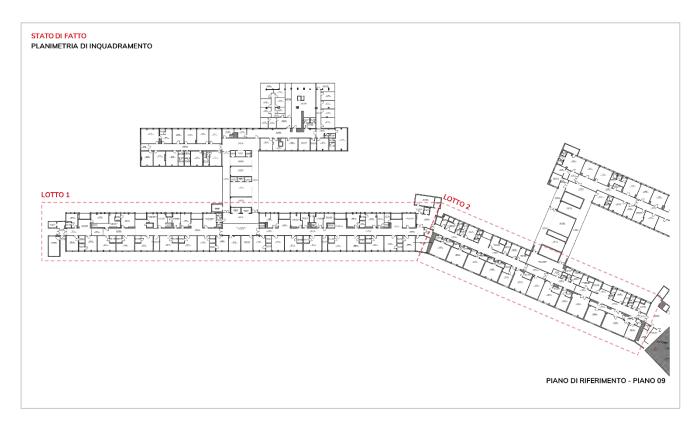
STATO DI FATTO: PLANIMETRIA PIANO TIPO DEI LOTTI 1 E 2
